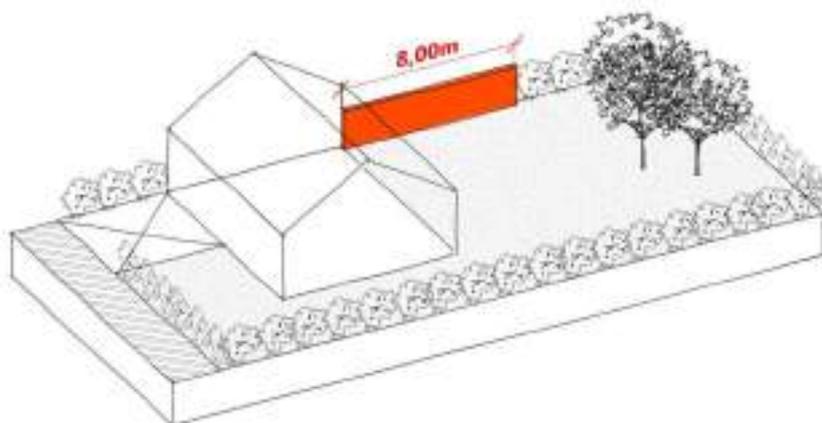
Implantation d'un mur en continuité avec la construction au niveau de la façade arrière
